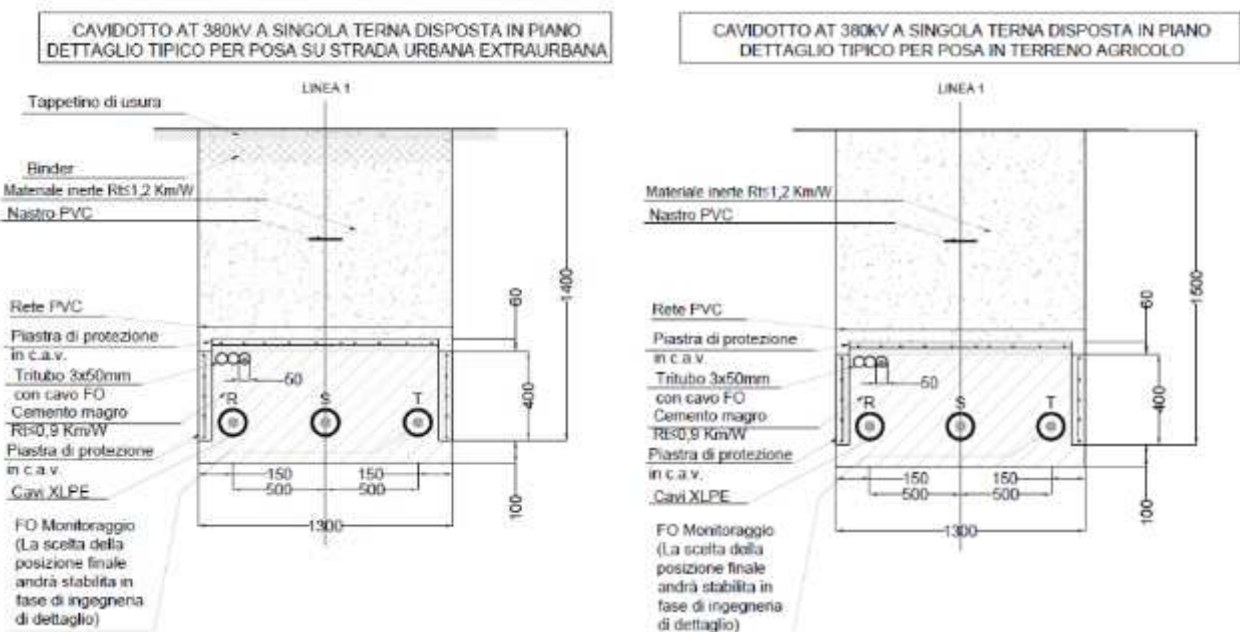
Sezione tipica di scavo e posa elettrodotto 380 kV su strada
